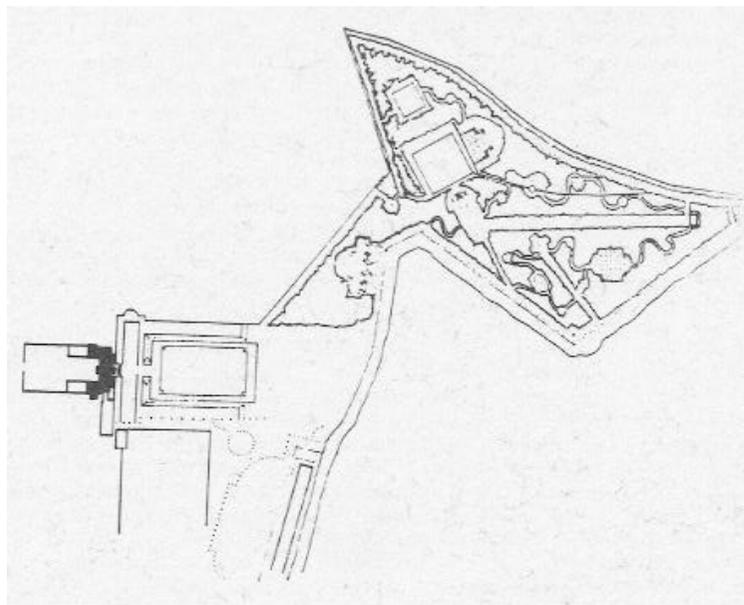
Planta-baixa jardim de Rousham, Oxford, Inglaterra.
